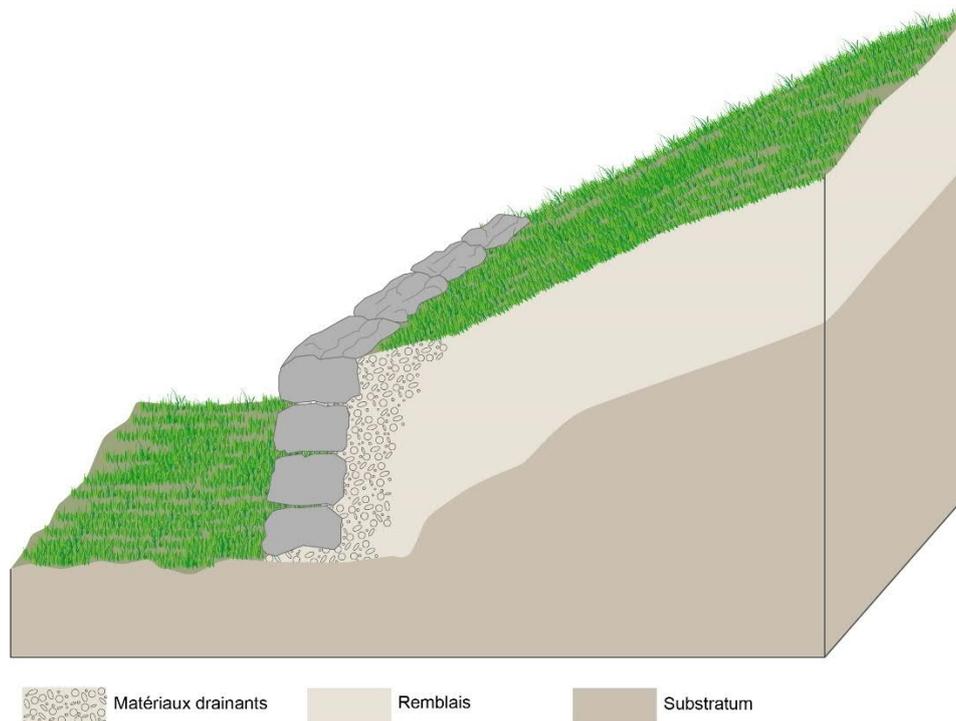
Exemple de renforcement en pied par mise en place d'un mur en enrochement
